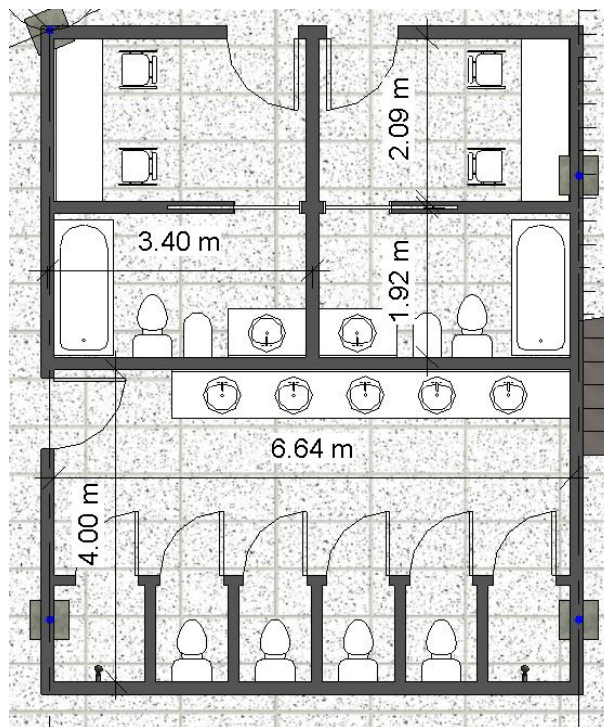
Vista en planta de los camarines individuales y los baños. Fuente:elaboración propia.
